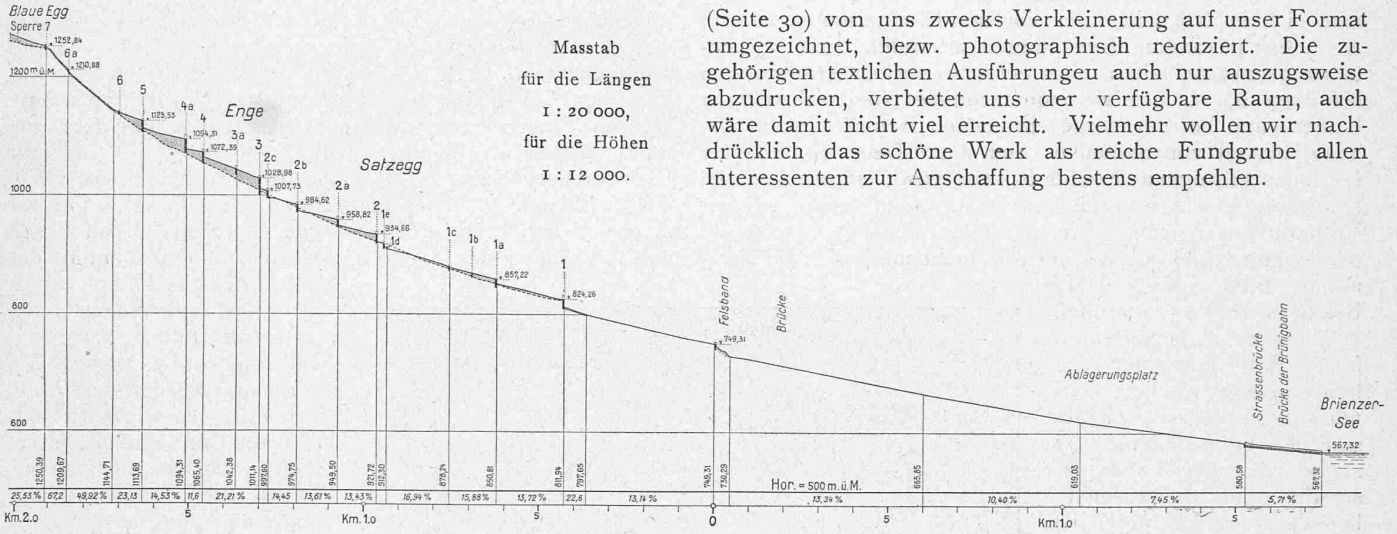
Längenprofil der Lammbach-Verbauung bei Brienz. — Abb. 2 (unten). Teilgrundriss.
